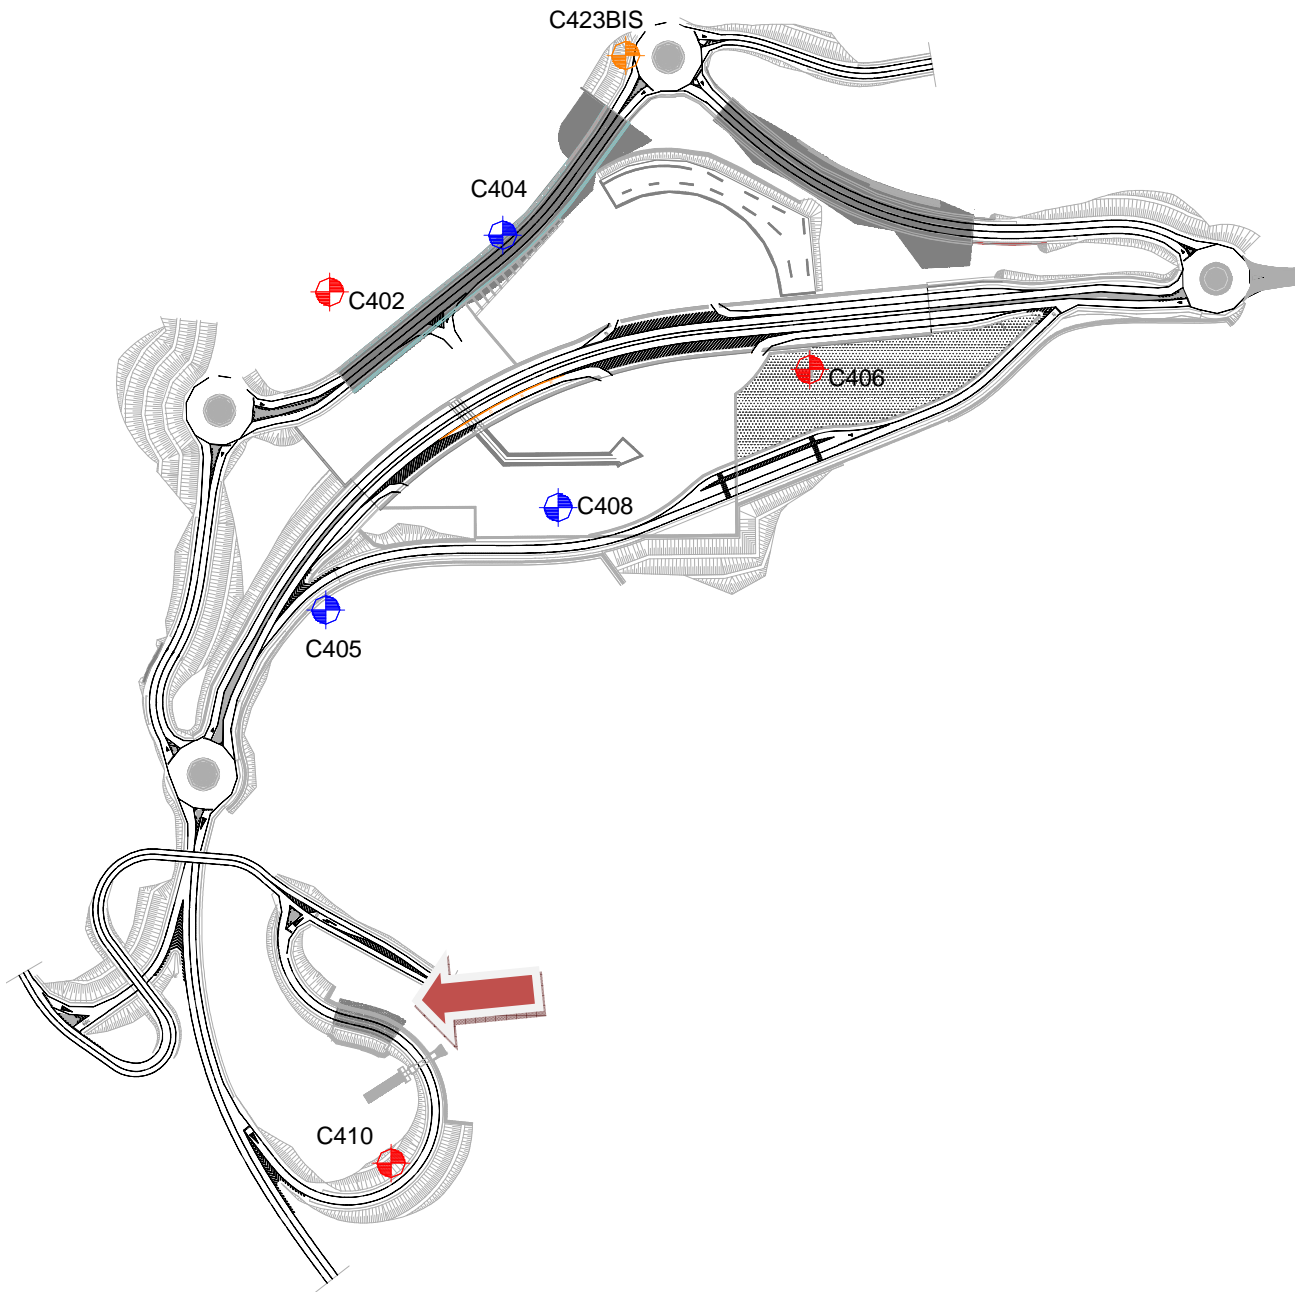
Stralcio planimetrico con ubicazione delle opere e dei sondaggi
